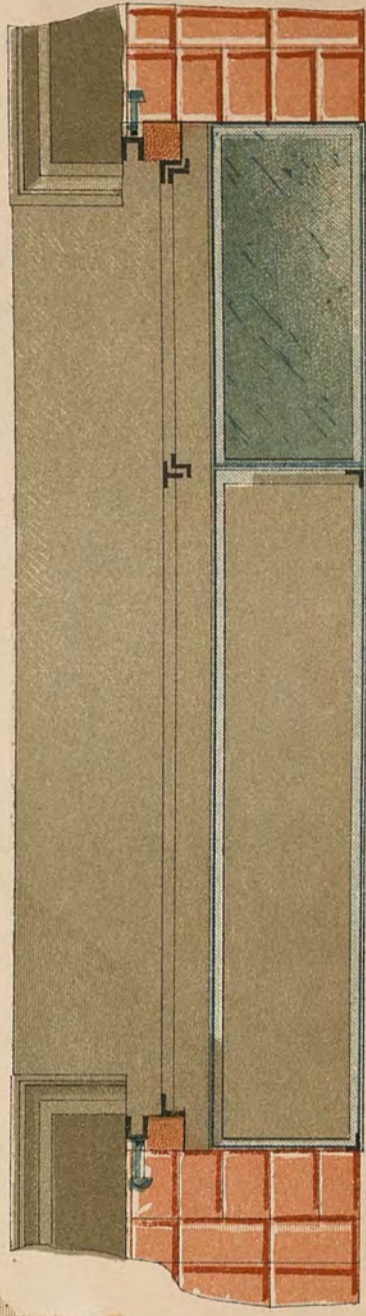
La sezione orizzontale della vetrina ed il retro-incastato nel pavimento
